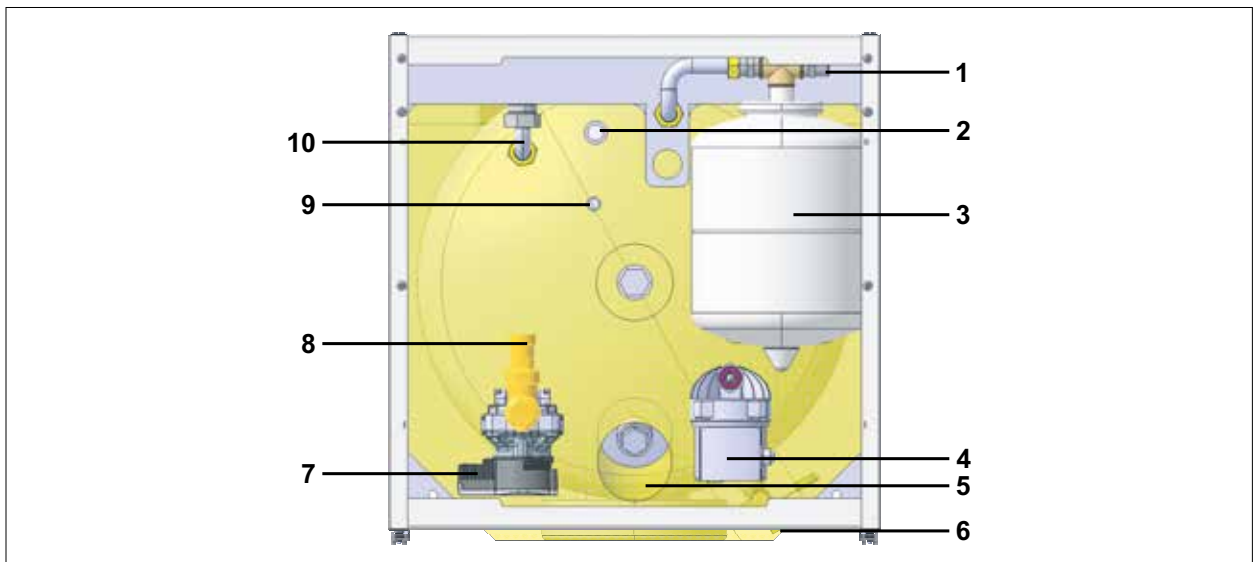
Детали водонагревателя косвенного нагрева TR
